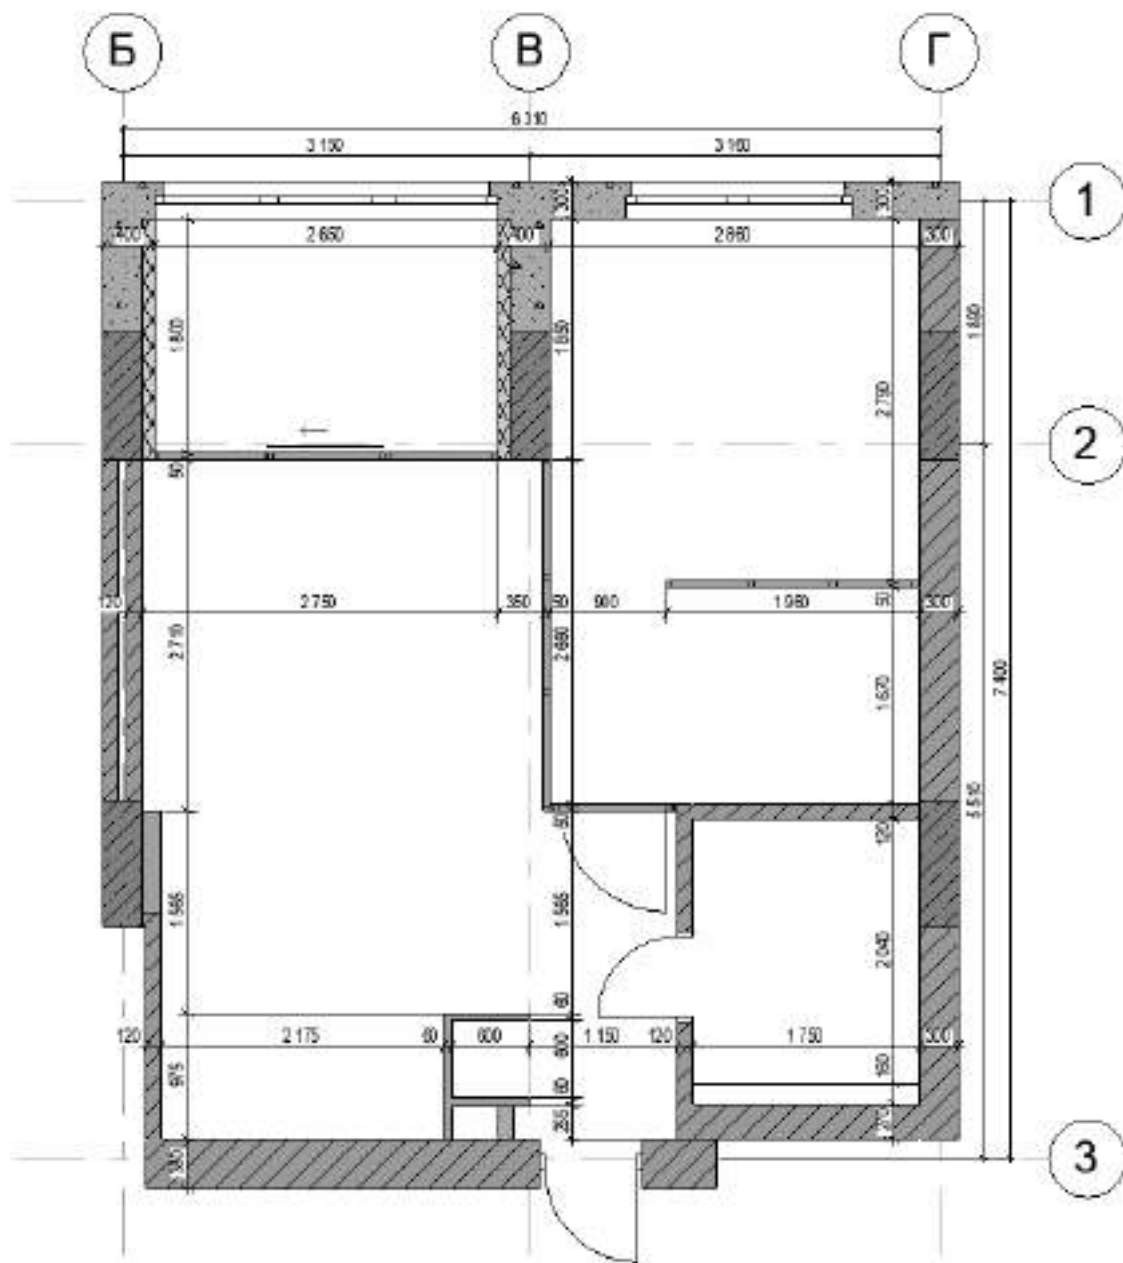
Обмірювальний план з переплануванням квартири
